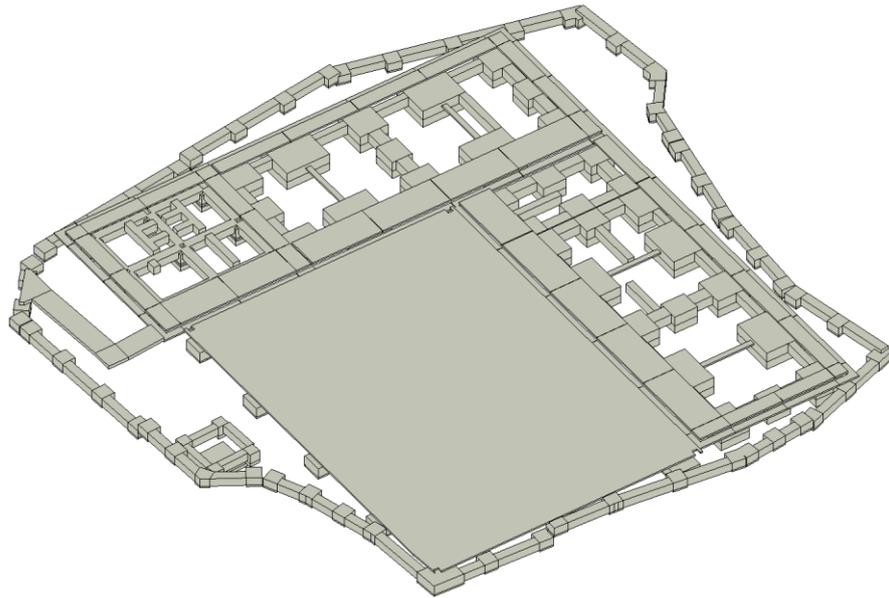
Categoría Cimentación Estructural aislada del modelo federado de Estructuras
